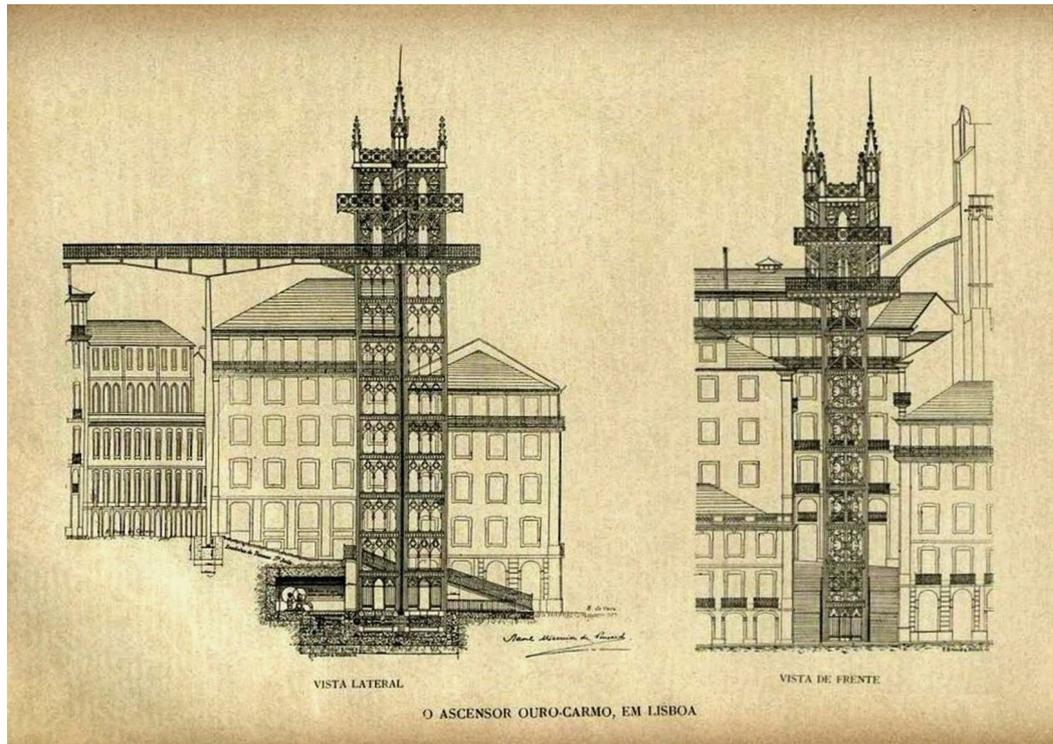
Progetto dell'Elevador de Santa Justa a Lisbona, prospetti. Raoul Mensier De Ponsard, 1901.
